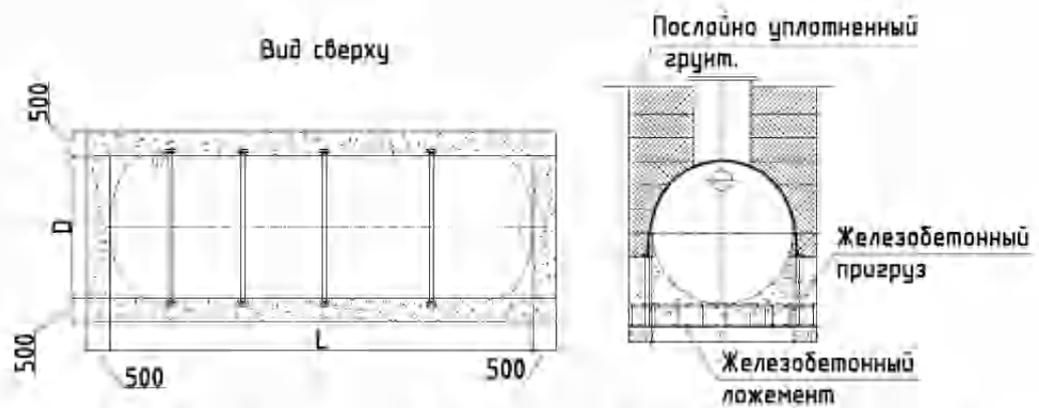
Пример монтажа оборудования при высоком уровне грунтовых вод
